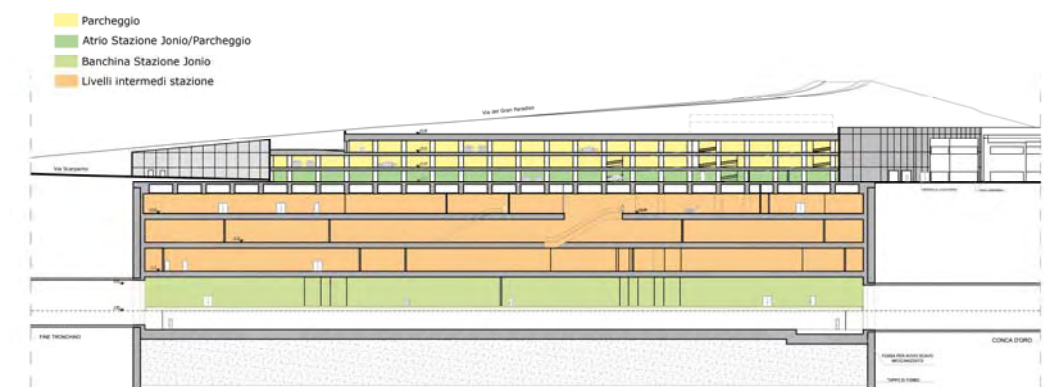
Stazione Jonio. Sezione longitudinale
